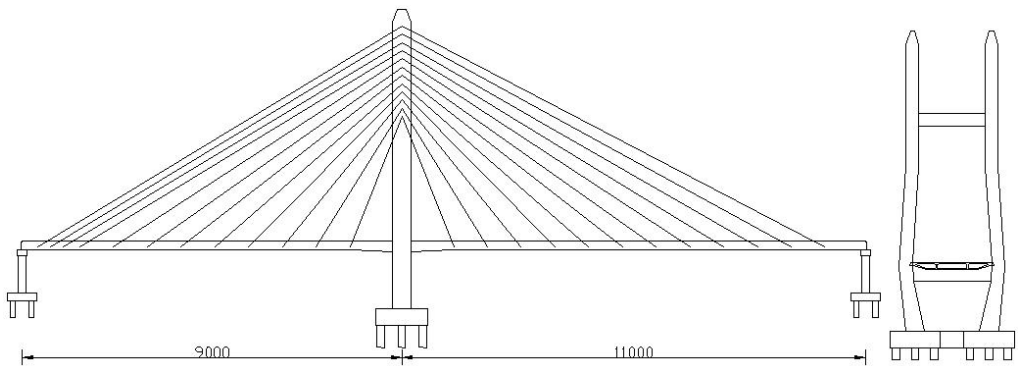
固城湖大桥主桥结构布置示意图（尺寸单位：cm）
